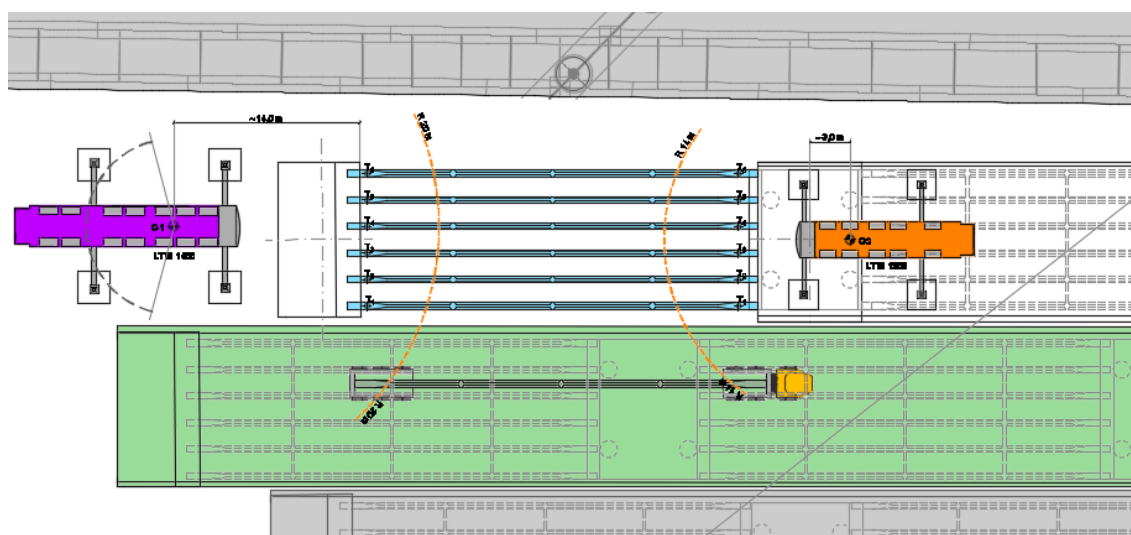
Piazzamento mezzi di sollevamento campata C1
